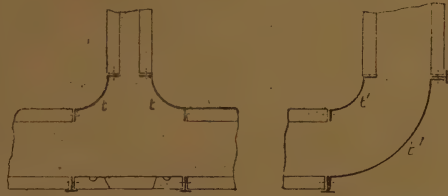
Fers d'angle. Fig. 10. — Rencontre du mur de façade et d'un mur de refend.
